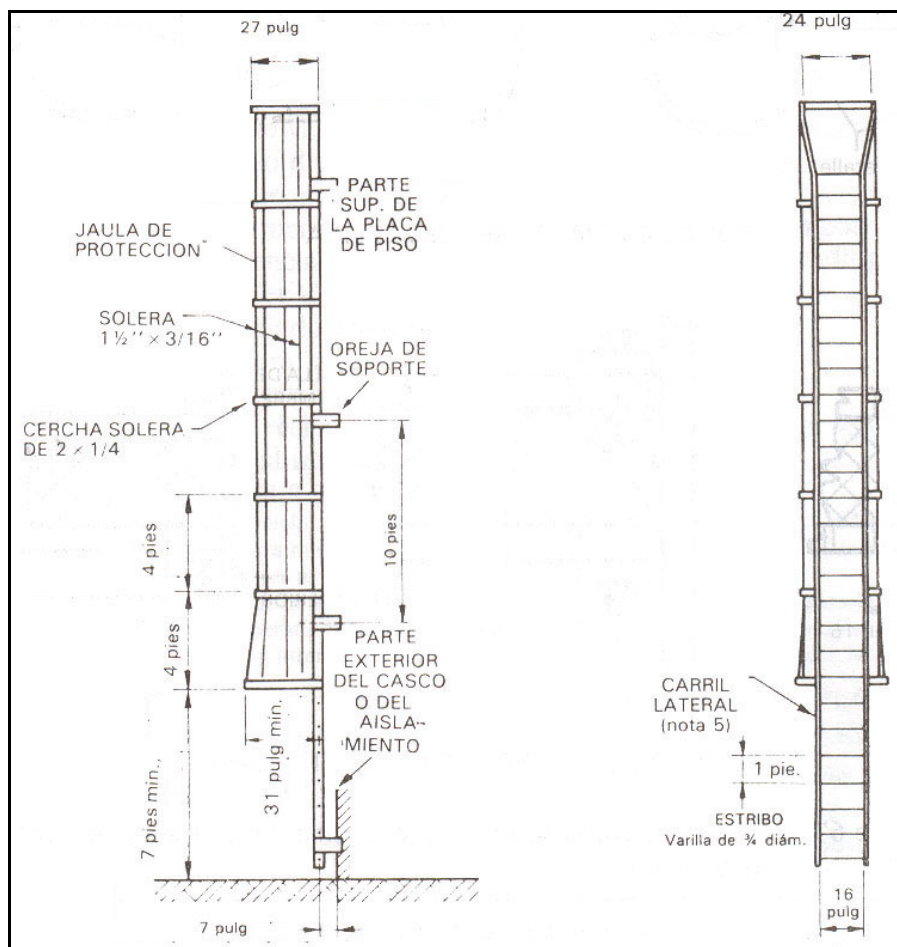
Detalle de la geometría de la escalera [8].
